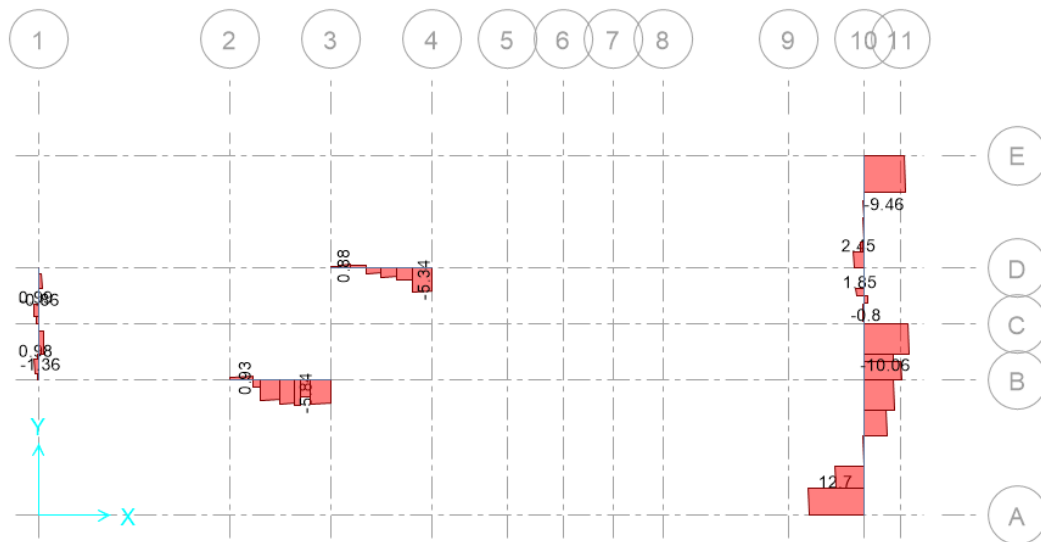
Cortantes en Vigas de Cimentación (Ton)
